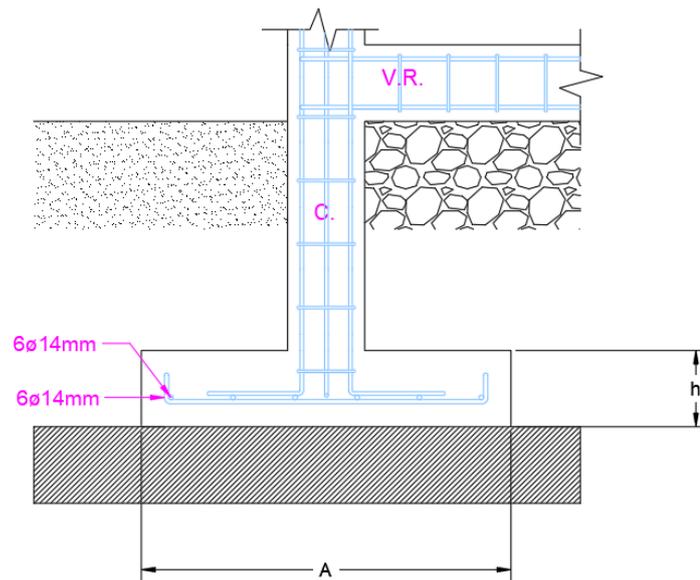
Detalle de zapatas en plano estructural [AutoCad]
